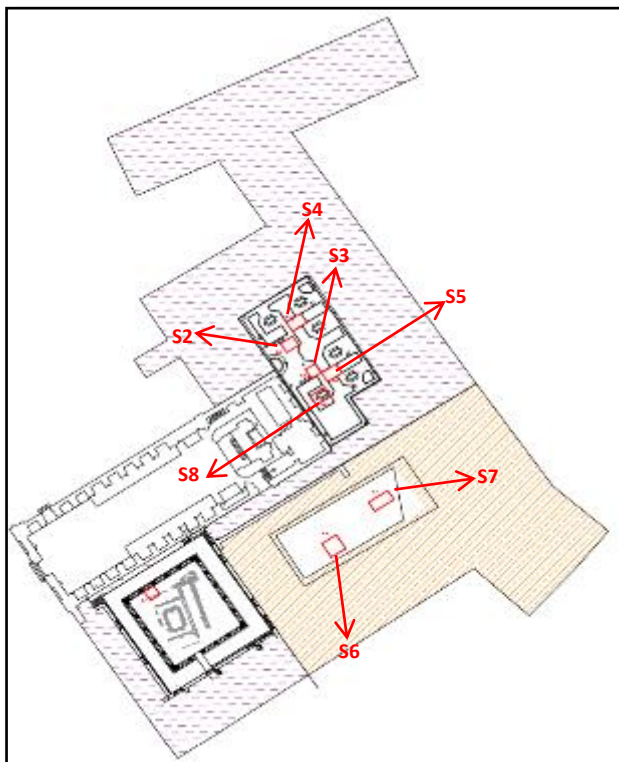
Planta das sondagens realizadas (UAUM, 2016)
